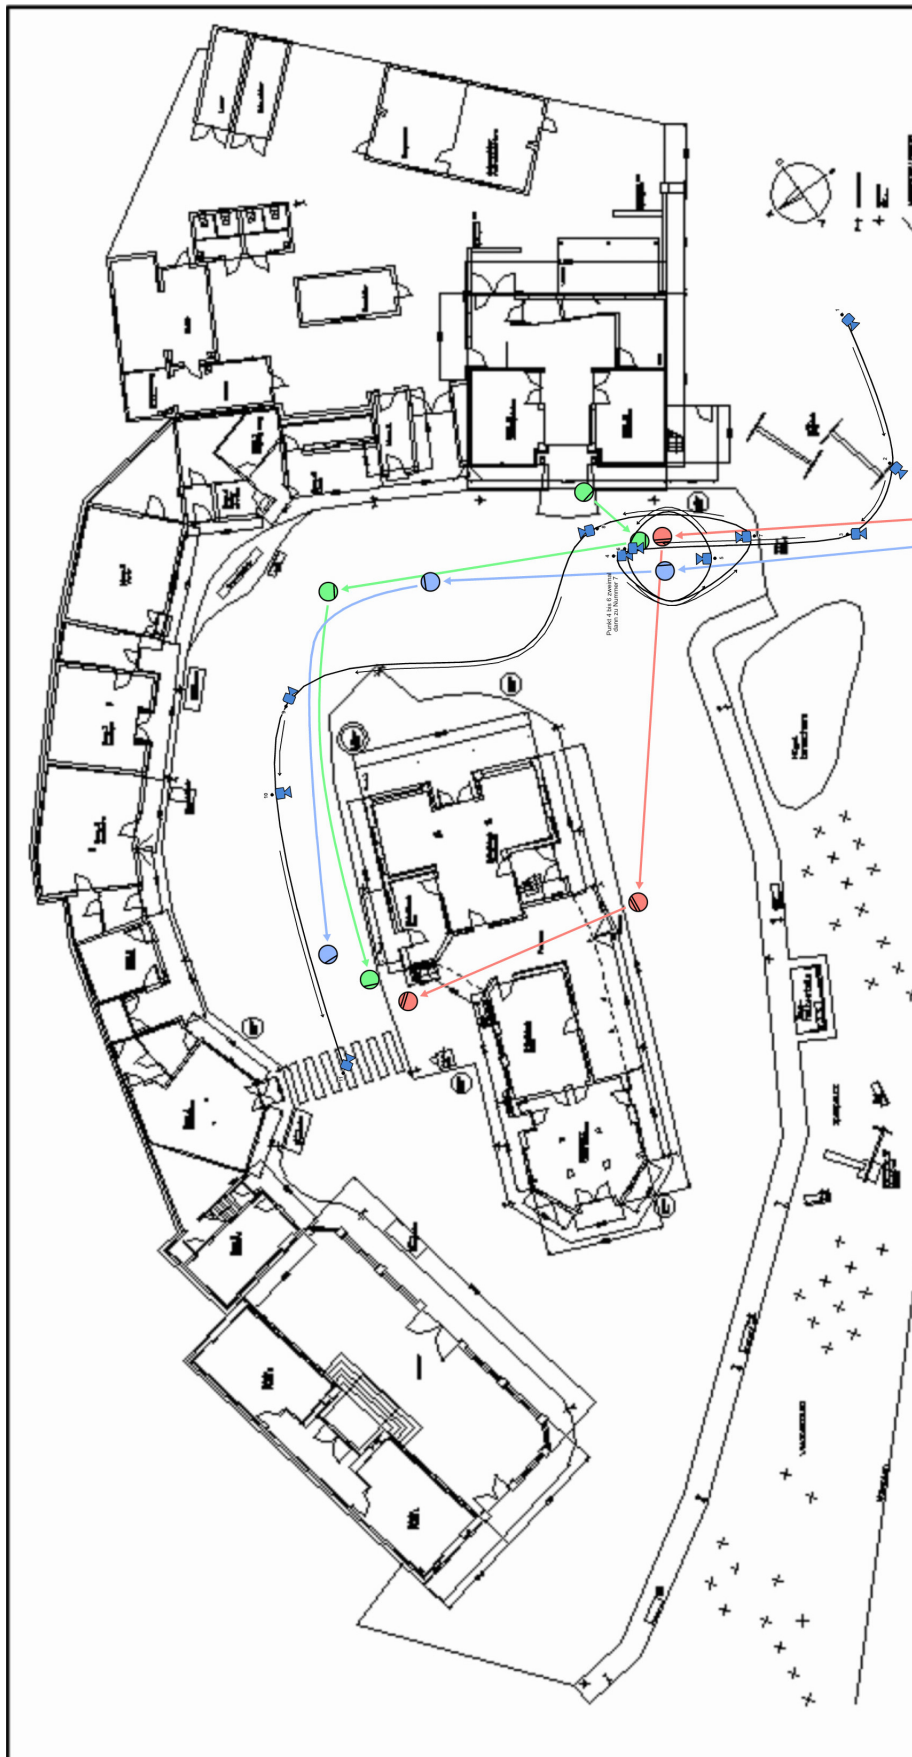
Floorplan der Plansequenz in der ehemaligen Kulissenstraße der TV-Serie „Marienhof“
